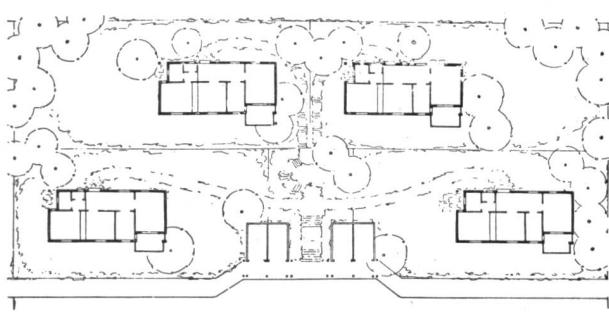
Plan einer Bebauungsgruppe, die lange und schmale, d. h. hygienische und wirtschaftliche Grundrisse zulässt.
